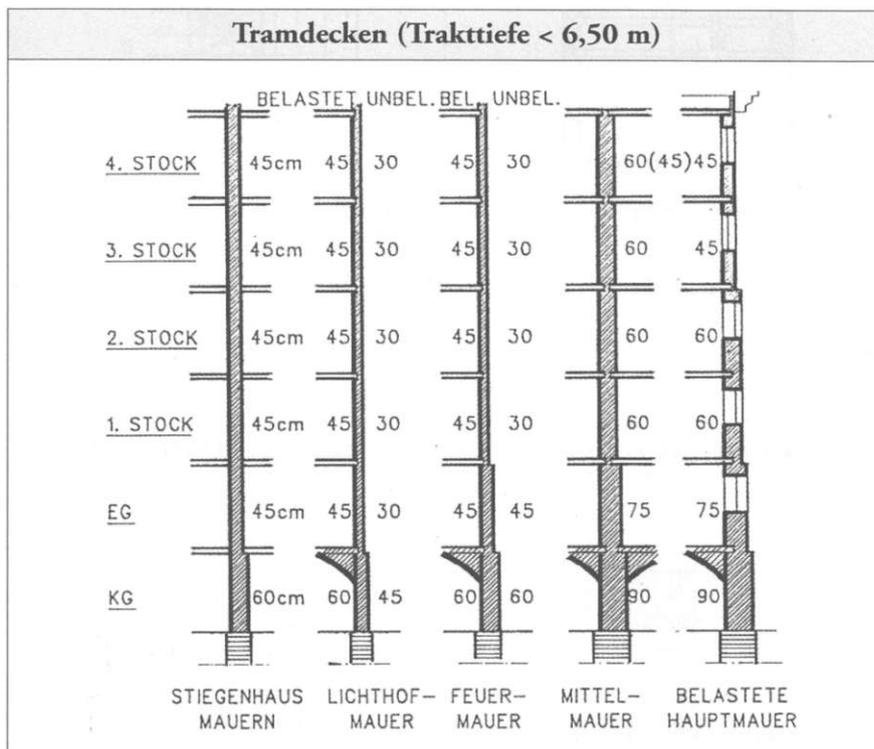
Festlegungen zur Wandabmessung lt. Wiener BO 1859 [74]
